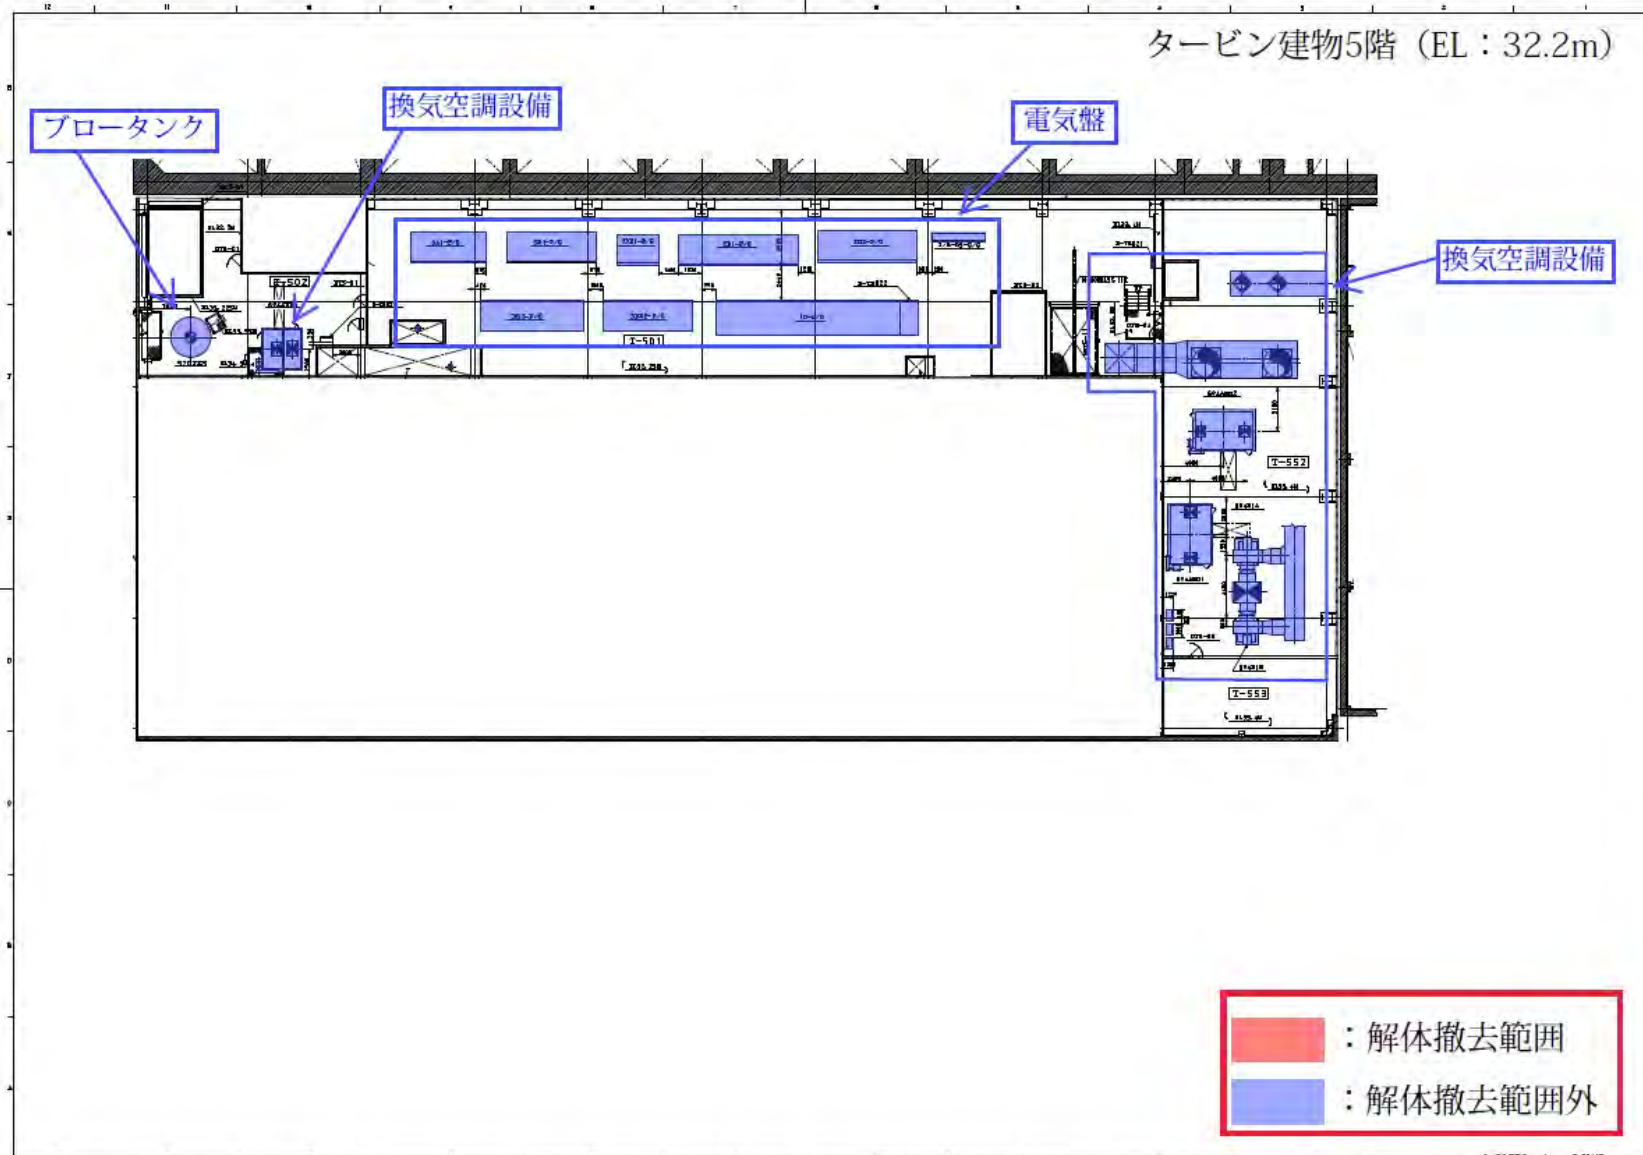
主な解体撤去機器 (タービン建物平面図) (2/7)
